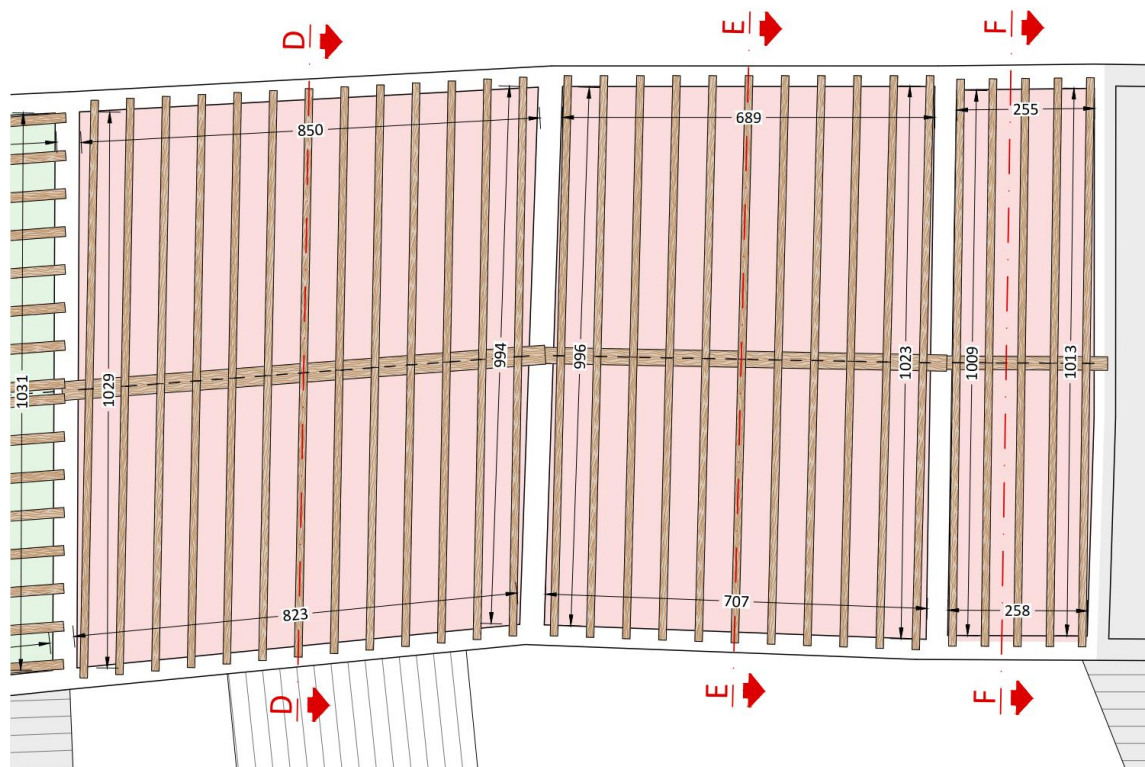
Pianta copertura dei blocchi D,E,F
